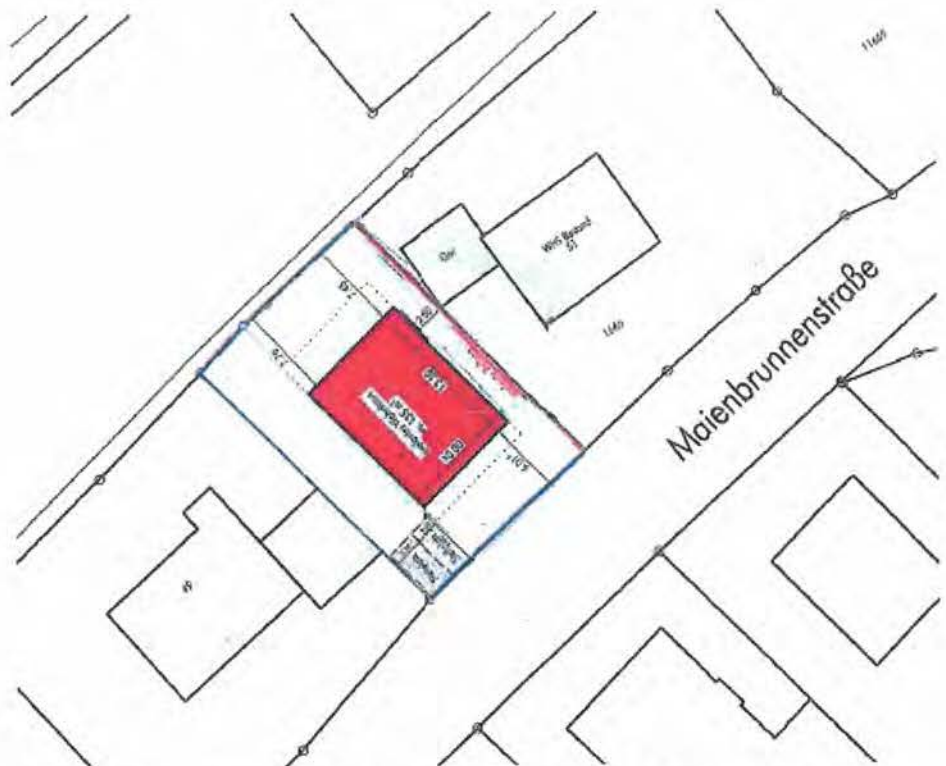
Lage und Umfang des vorgesehenen Baufensters (Detail)
